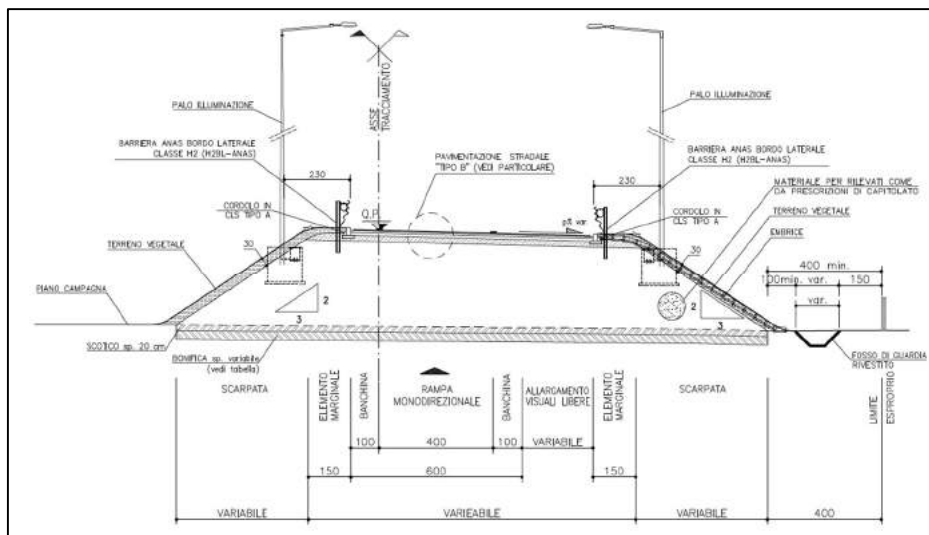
Sezione tipo in rilevato. Embrici e fosso di guardia al piede del rilevato
